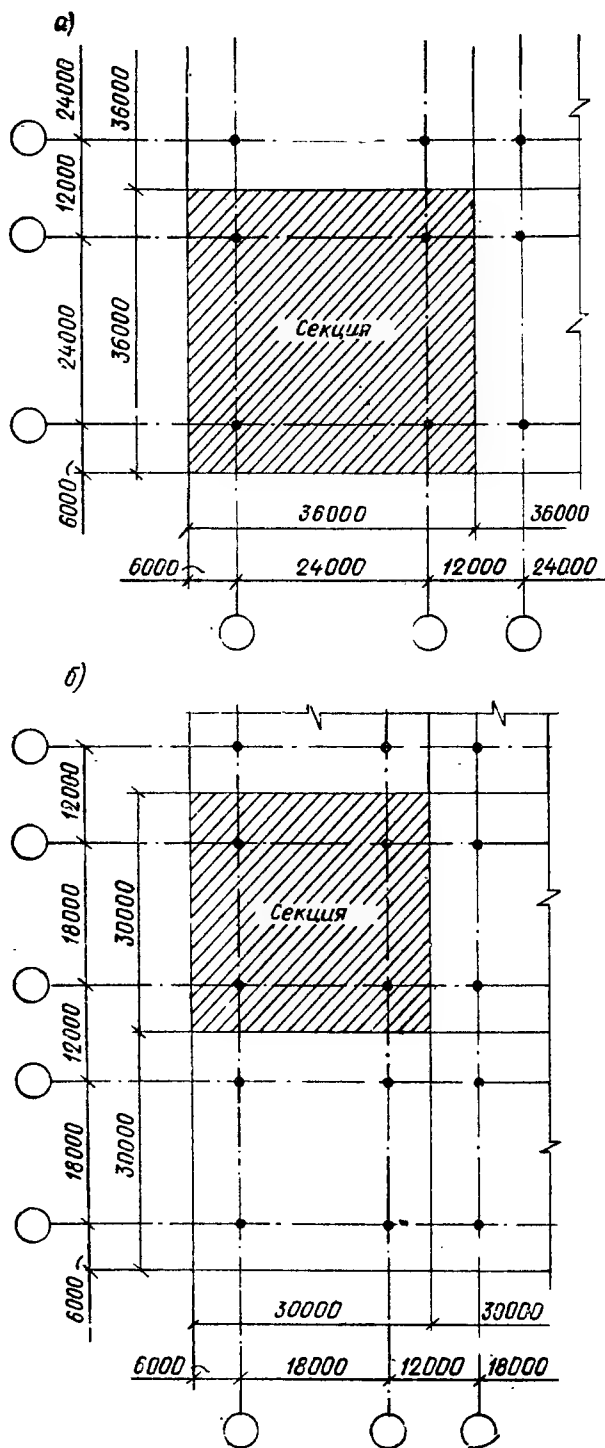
Схематические планы зданий с конструкциями типа «Кисловодск»
